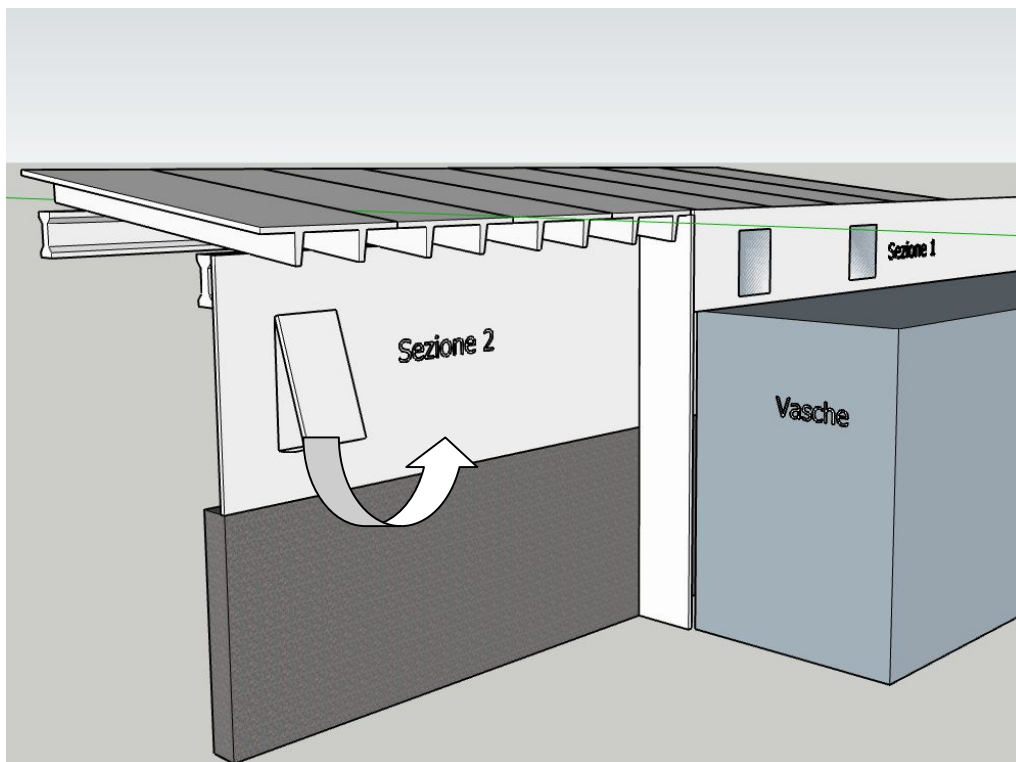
Vista zona di collegamento sezione 1 e 2 tettoia legno
